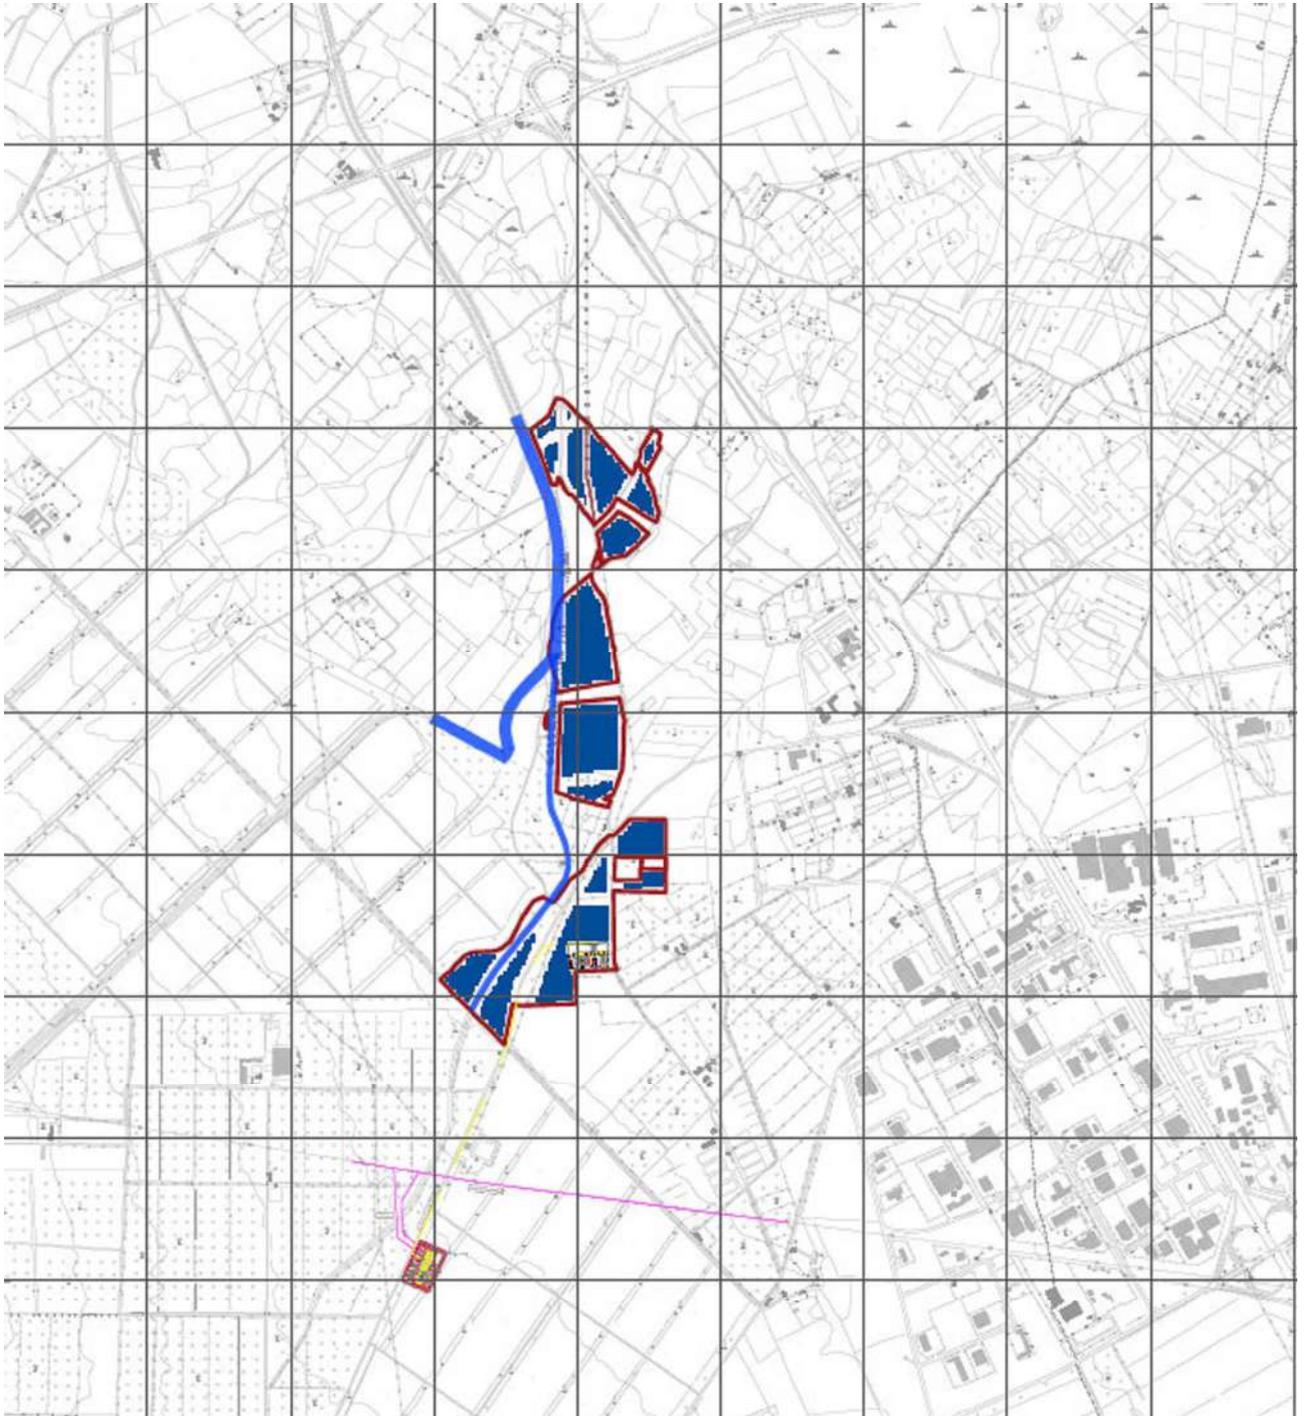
Stralcio della planimetria Impianto su C.T.R
